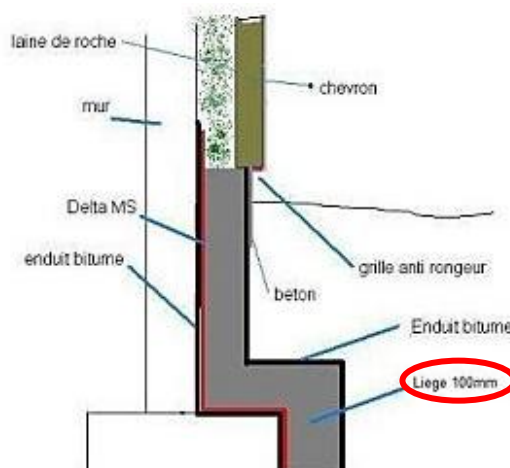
Isolation des fondations (Source : lamaison12travaux.com)
